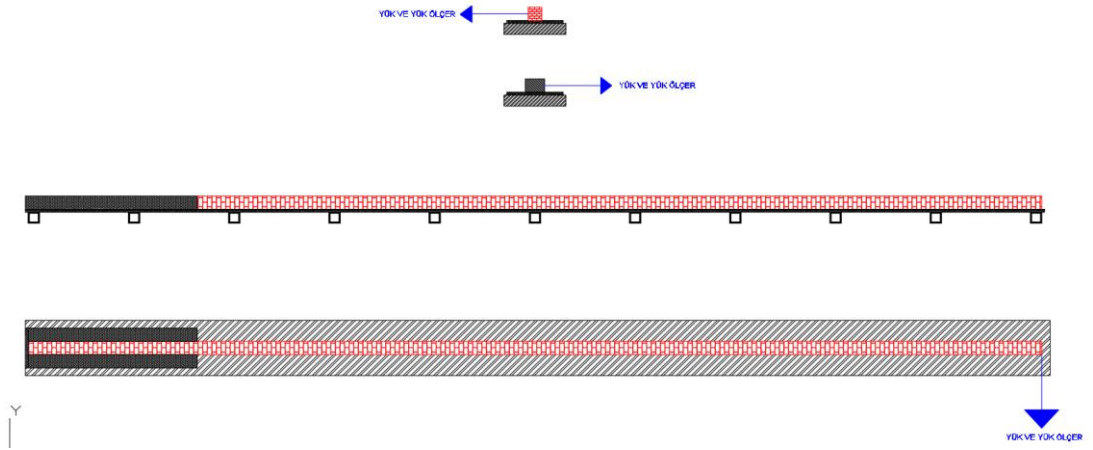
Planlanan eğilme deneyi AutoCAD çizimi
